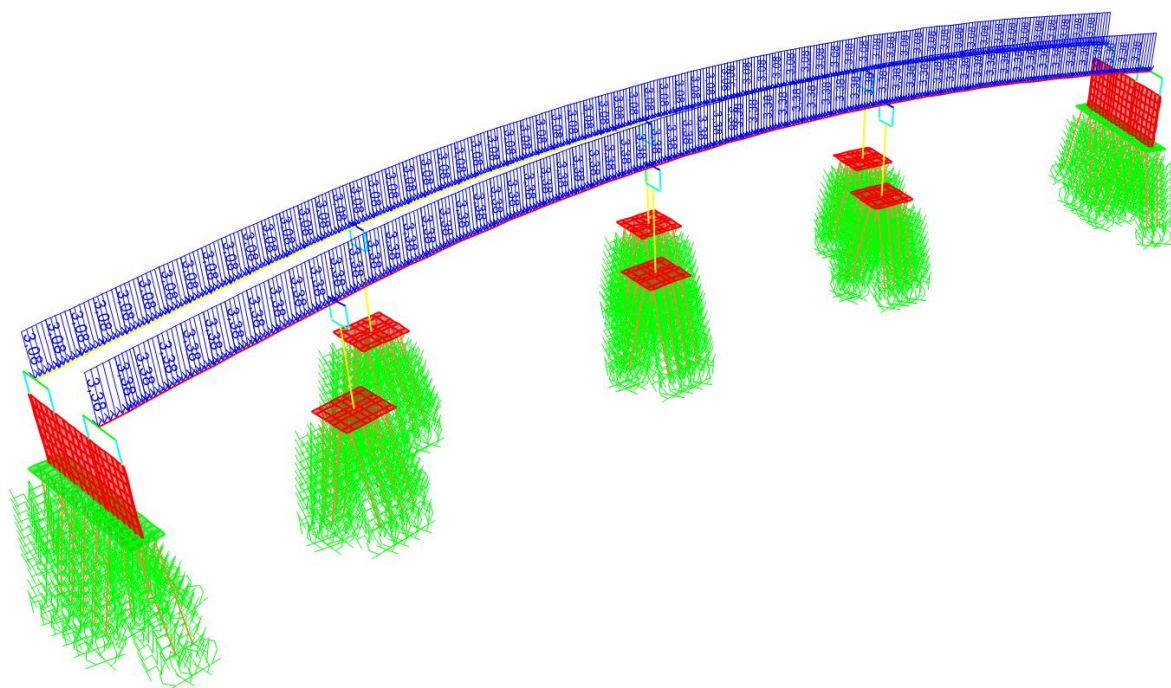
CARGA PERMANENTE (GUARDA-RODAS + PAVIMENTO + LAJE) (TONF/M)
